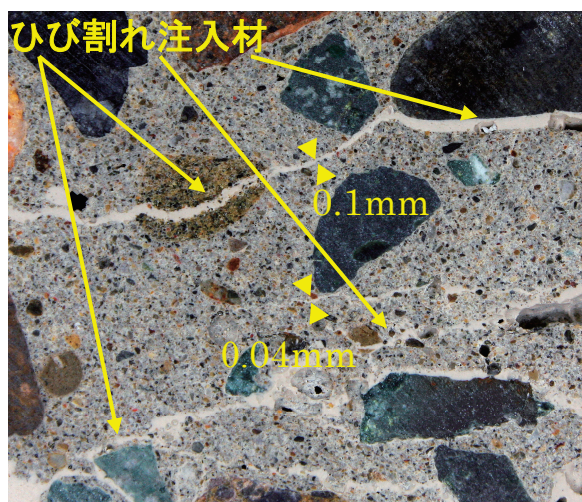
新開発ひび割れ注入材のひび割れ注入状況
